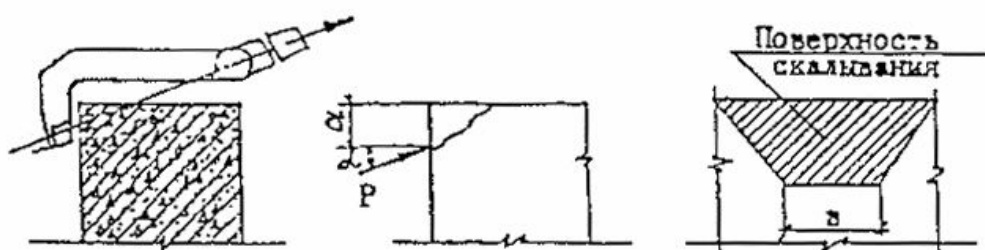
Схема испытания бетона в конструкциях методом скалывания ребра конструкции
